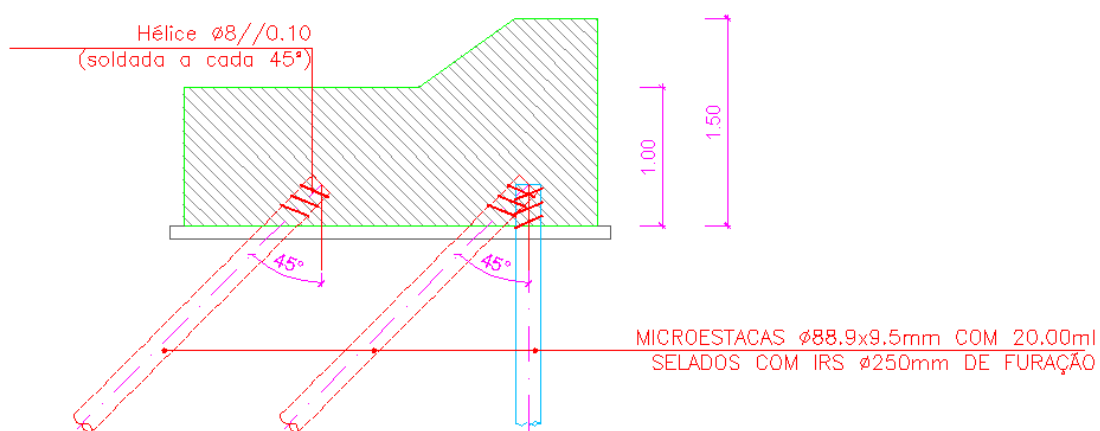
Corte transversal para fundações indiretas da ponte pedonal até 40m de vão
